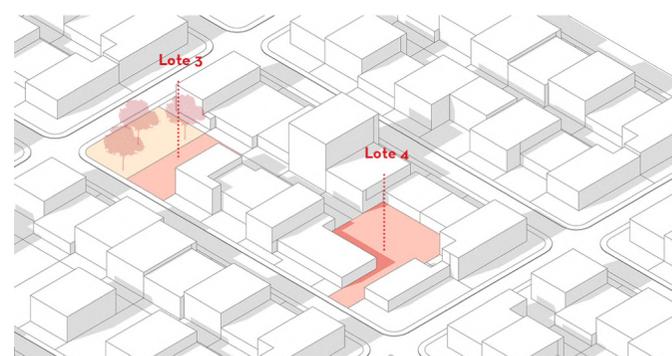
Isometría de Lote tipo 3 y Lote tipo 4
